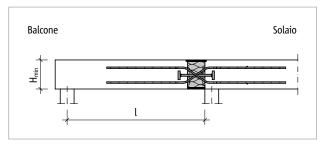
Schöck Isokorb® XT tipo QP-VV: schema statico
